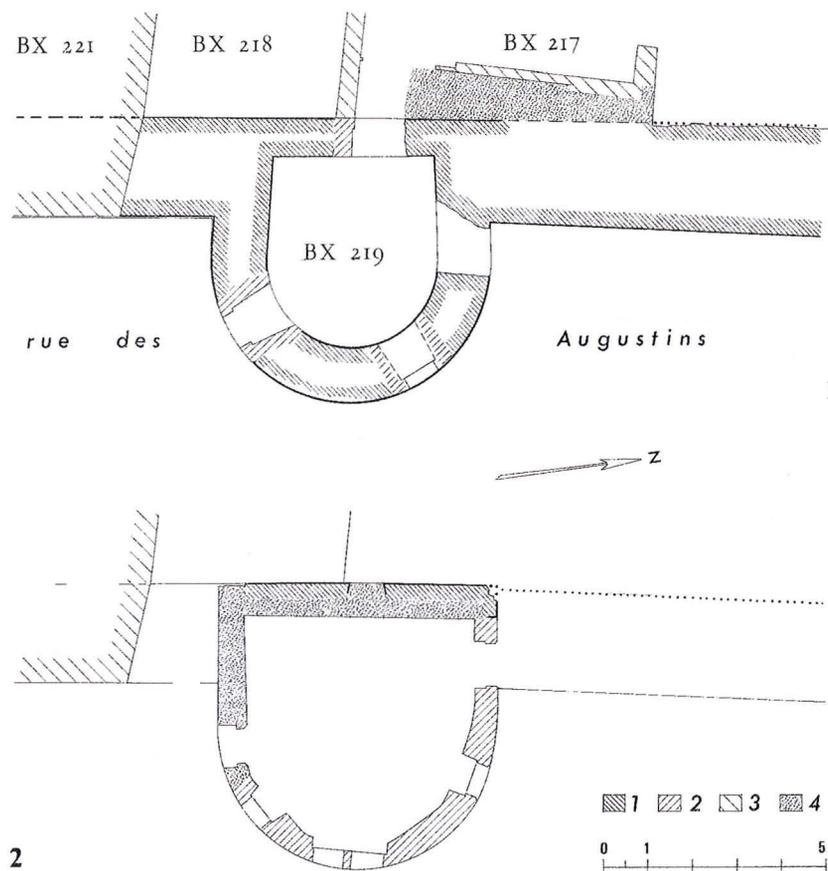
Plan des vestiges actuels : 1/ rez-de-chaussée ; 2/ étage.
